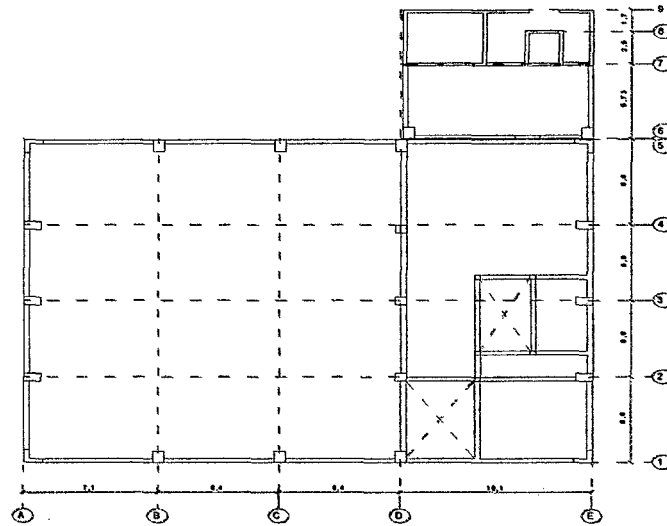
Planta los 2 primeros pisos del Canal 4
